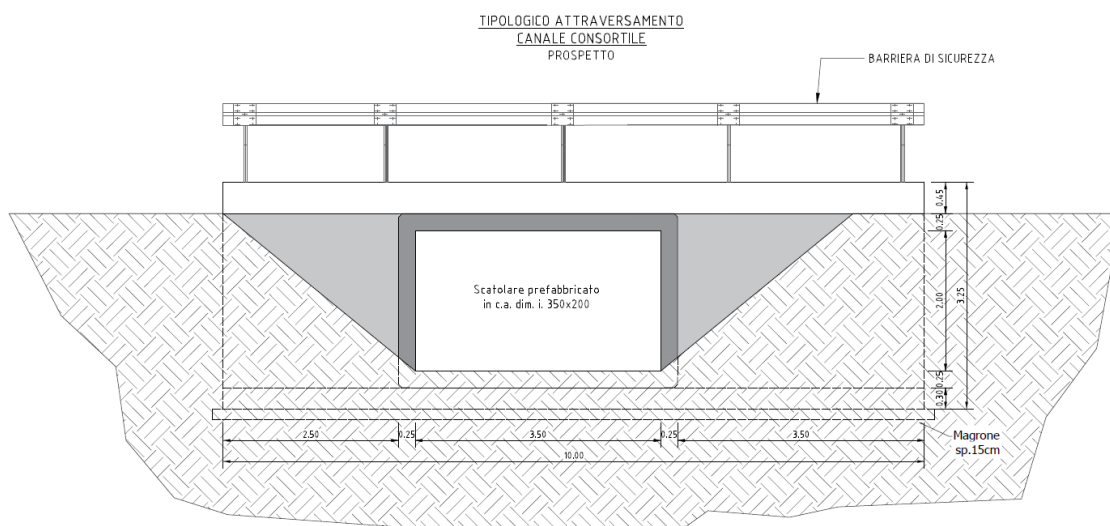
Prospetto tipologico attraversamento canale consortile
